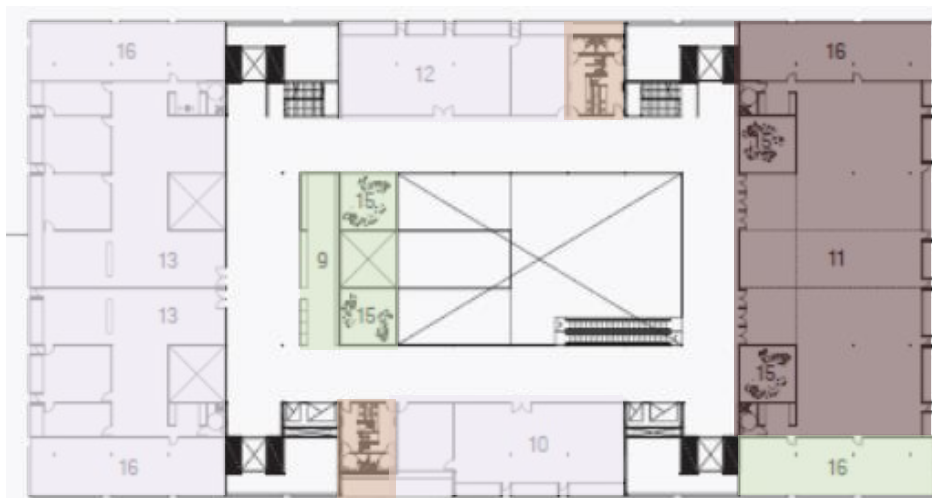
Planta primer nivel del centro cívico Rafaela
